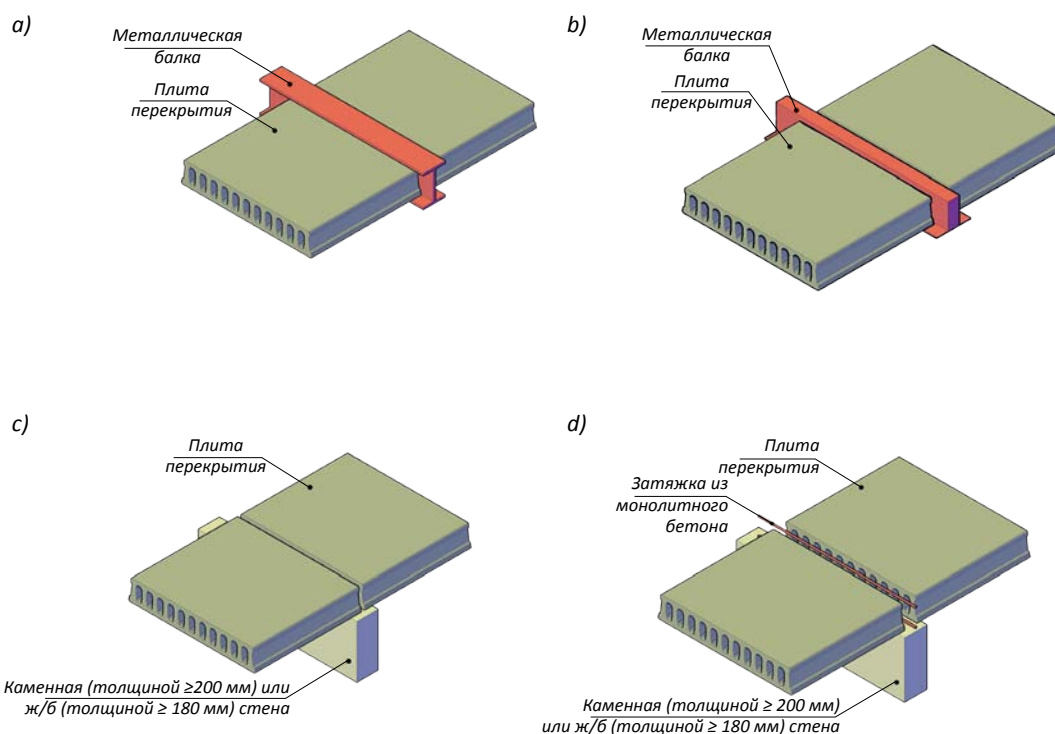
Опора плит на несущие конструкции: а, б – на металлические балки; с, д – на несущие стены.
